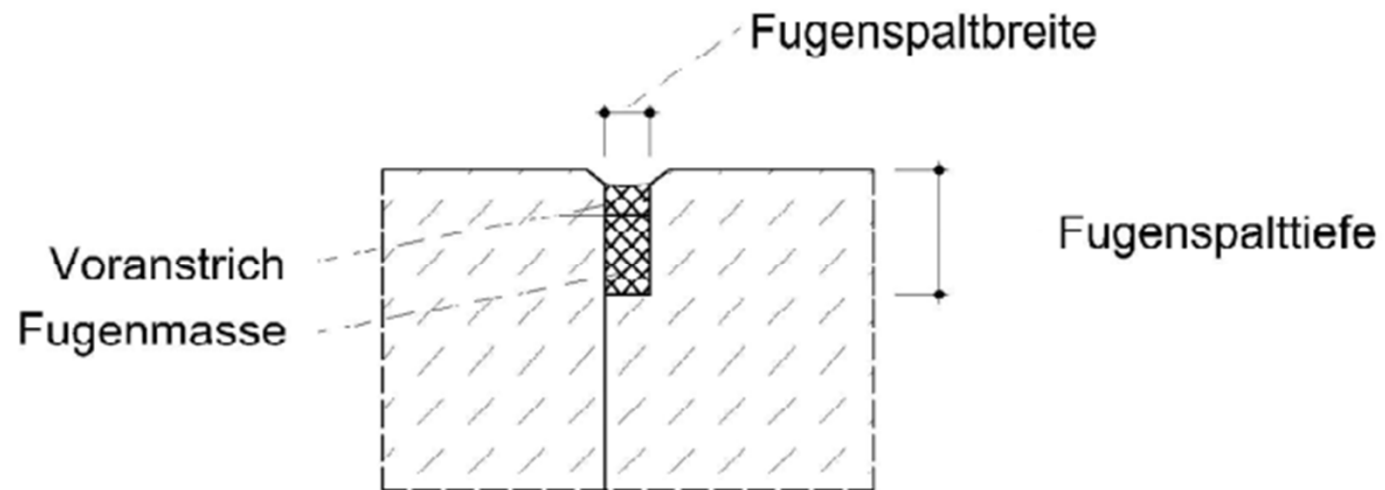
Pressfuge in Fahrbahndecken aus Beton
